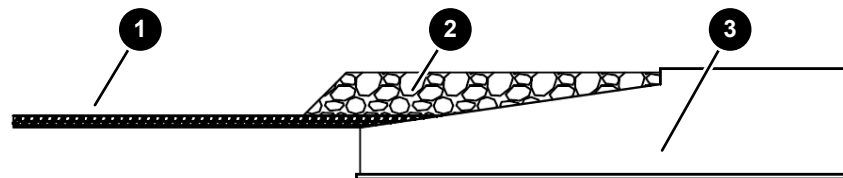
Fundament Teilanschüttung mit Erdauflast
